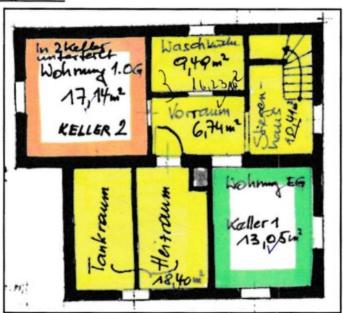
Grundrissplan Kellergeschoß
